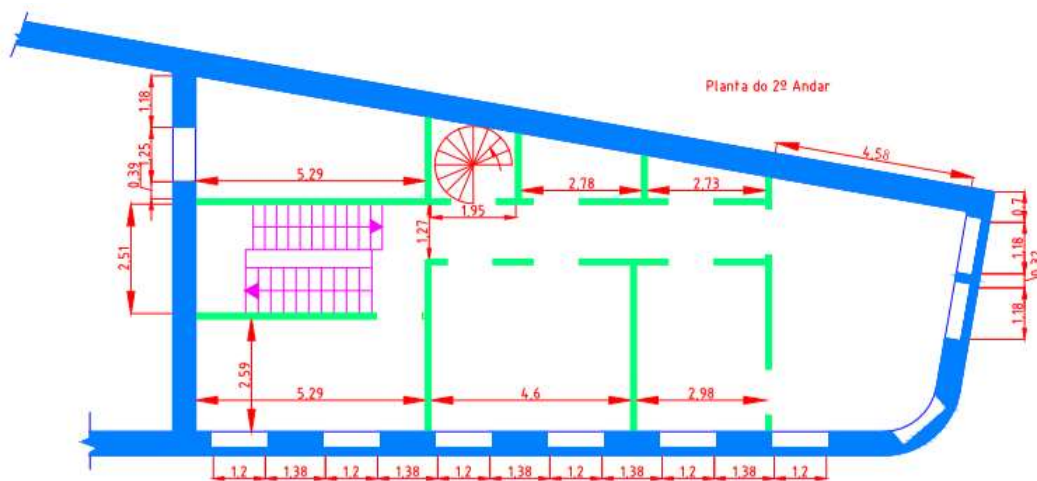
Planta Arquitetura do Levantamento/Existente do 2º Andar
